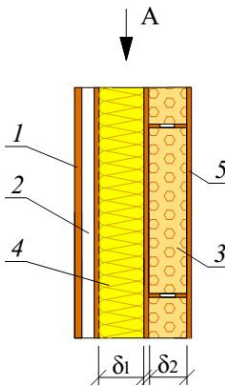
Конструкция стены из легких керамических блоков с наружным утеплением: 1 – обшивка; 2 – 20 мм вентилируемого слоя; 3 – керамические блоки (кирпичи); 4 – теплоизоляция; 5 – стяжка; 6 – рейка с шагом 0,6 м; 7 – облицовка
